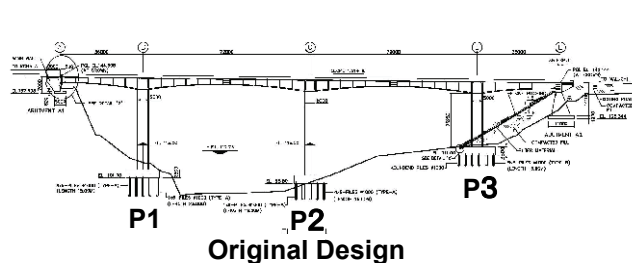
Naluchi 橋施工済み基礎杭施工状況図
